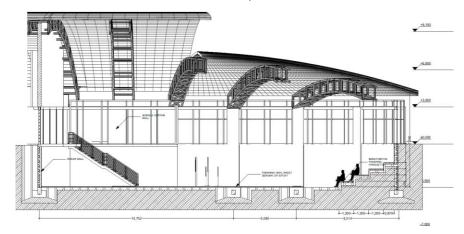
17 Potongan Bnagunan B1-B1 (R. Kolam Renang)
